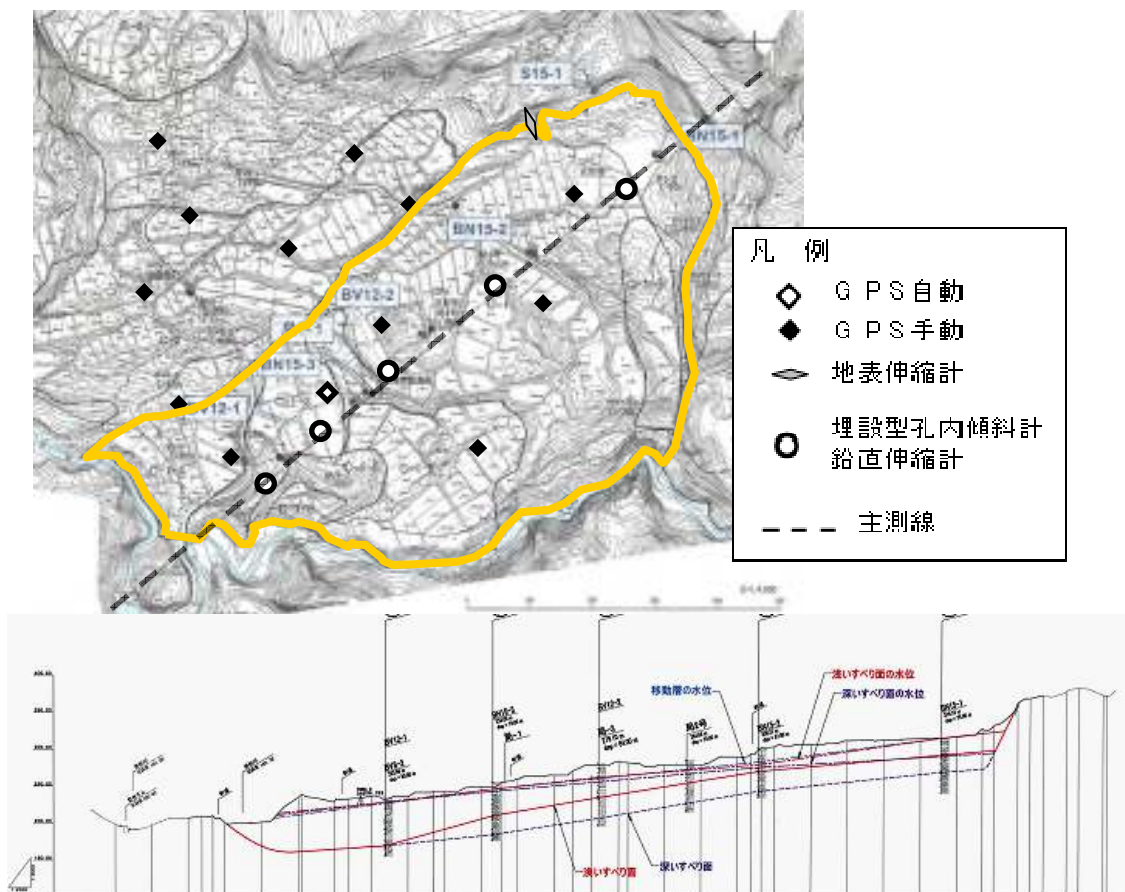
滝ノ沢Cブロックの平面図と主測線断面図
